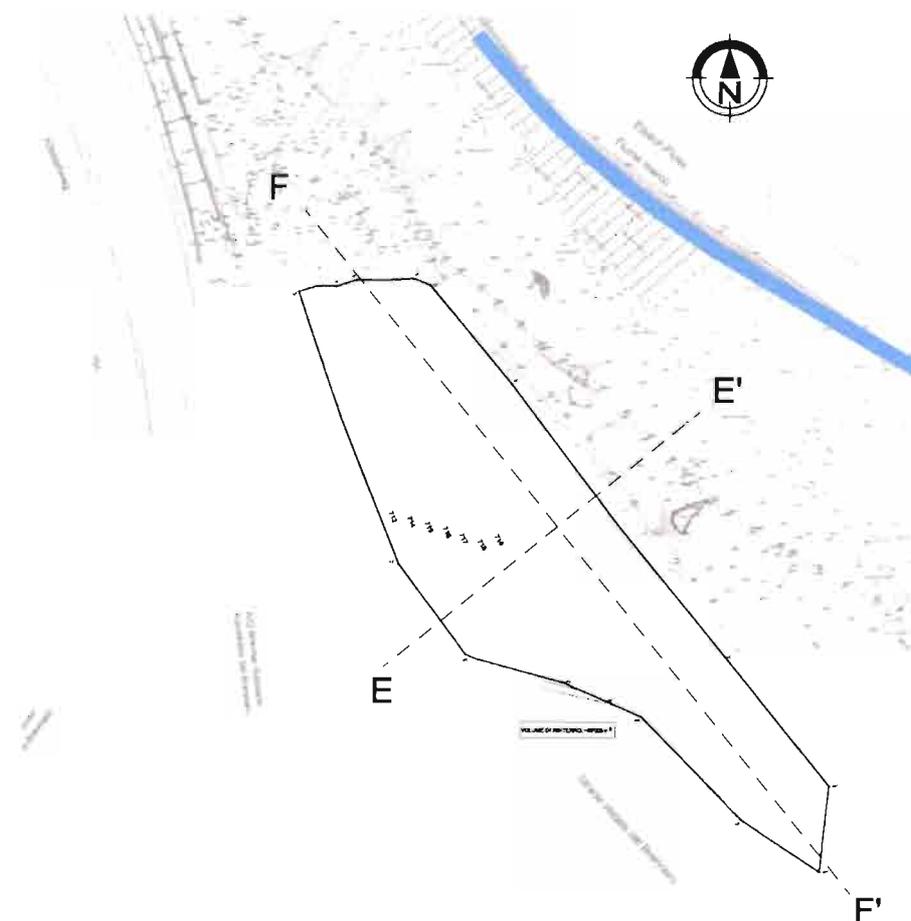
Planimetria di ripristino del sito Plattner.
